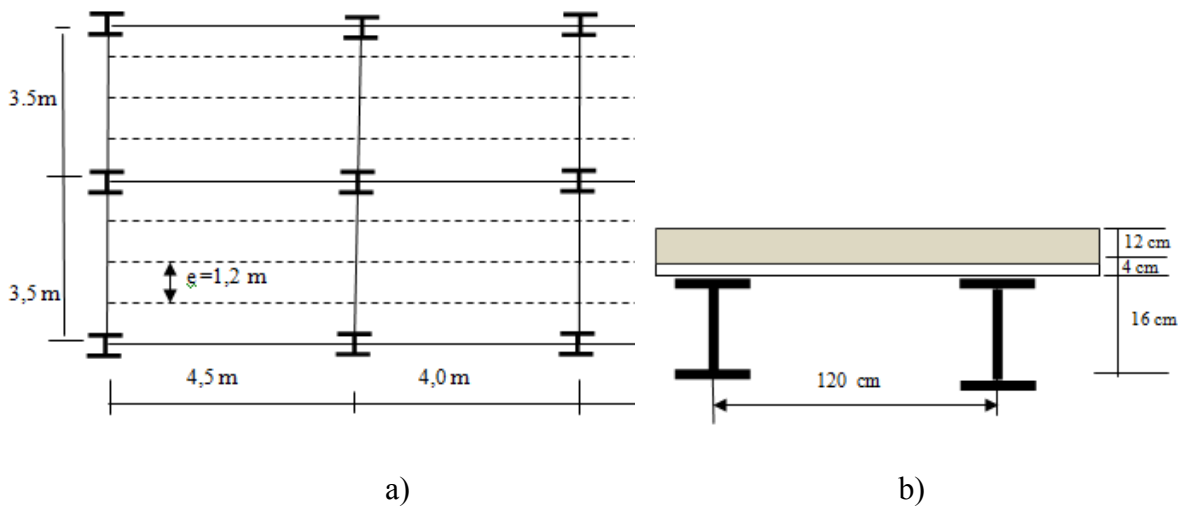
présentation d'un plancher mixte ; a) plan d'un étage courant, b) coupe transversal d'un plancher mixte
